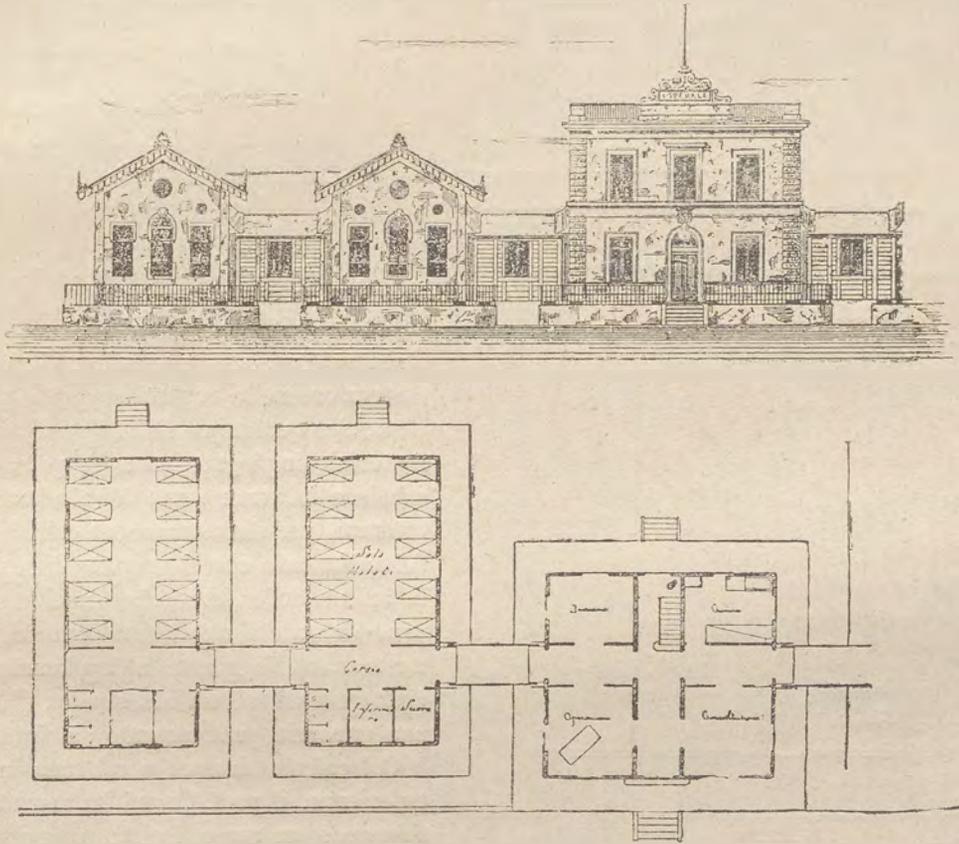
Facciata e pianta d'un ospedale. - Proposta dell'ing. Regnòli.
